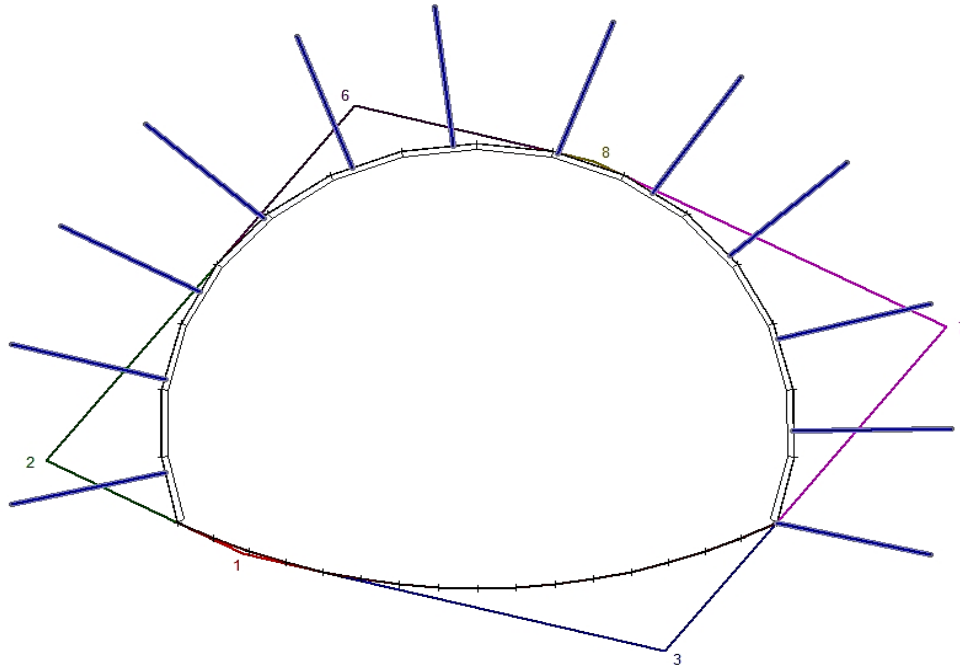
Sección con Bulones y Hormigón proyectado recomendado por Romana. Elaboración Propia.
